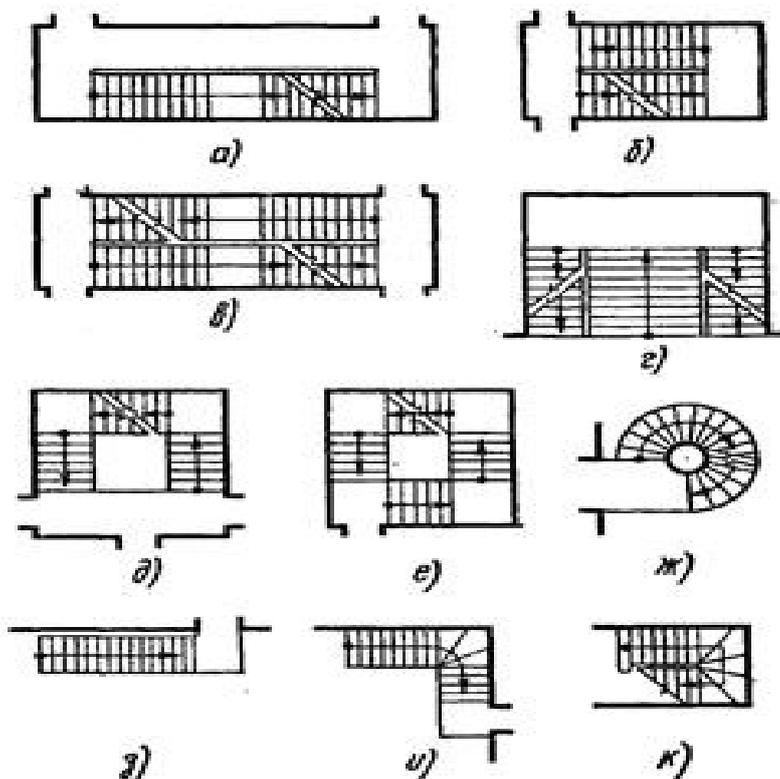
Виды лестниц: а, б – двухмаршевая; в – то же, с перекрещивающимися маршами; г – то же, с парадным средним маршем; д – трехмаршевая; е – четырех-маршевая; ж – винтовая; з – одномаршевая внутриквартирная; и, к – внутриквартирная с забежными ступенями
